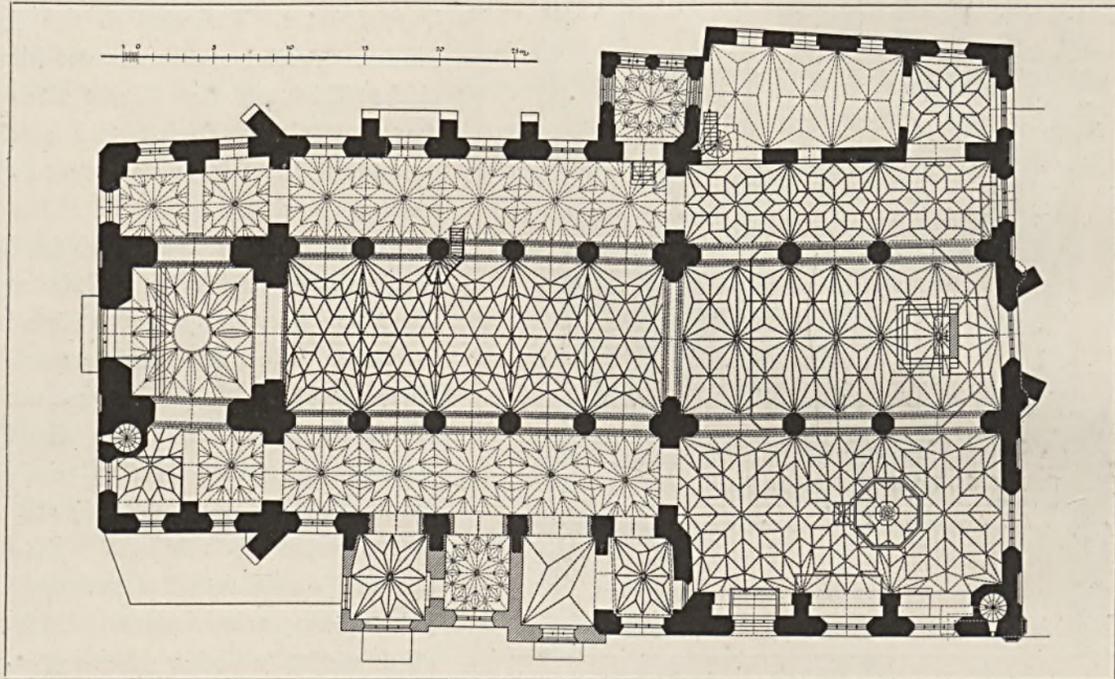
Katharinenkirche. Grundriss. (G.)
